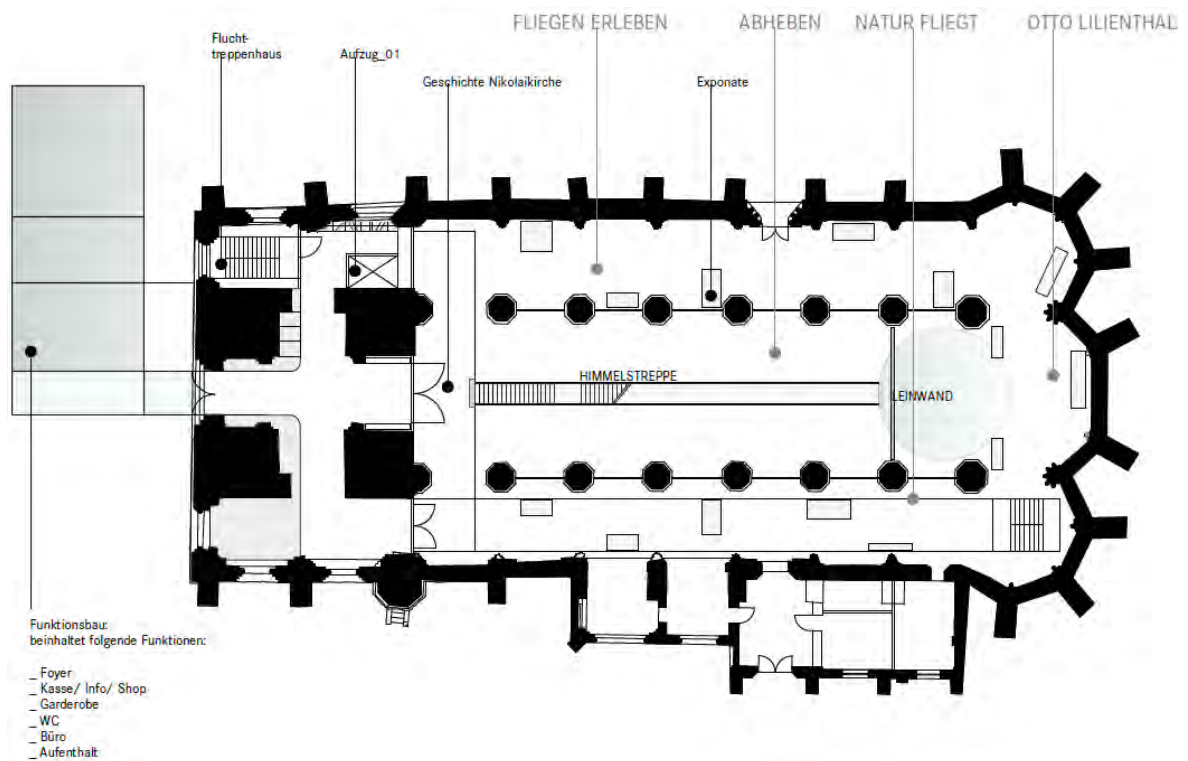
Grundriss des Foyer- Ausstellungsbereiches im Erdgeschoss
